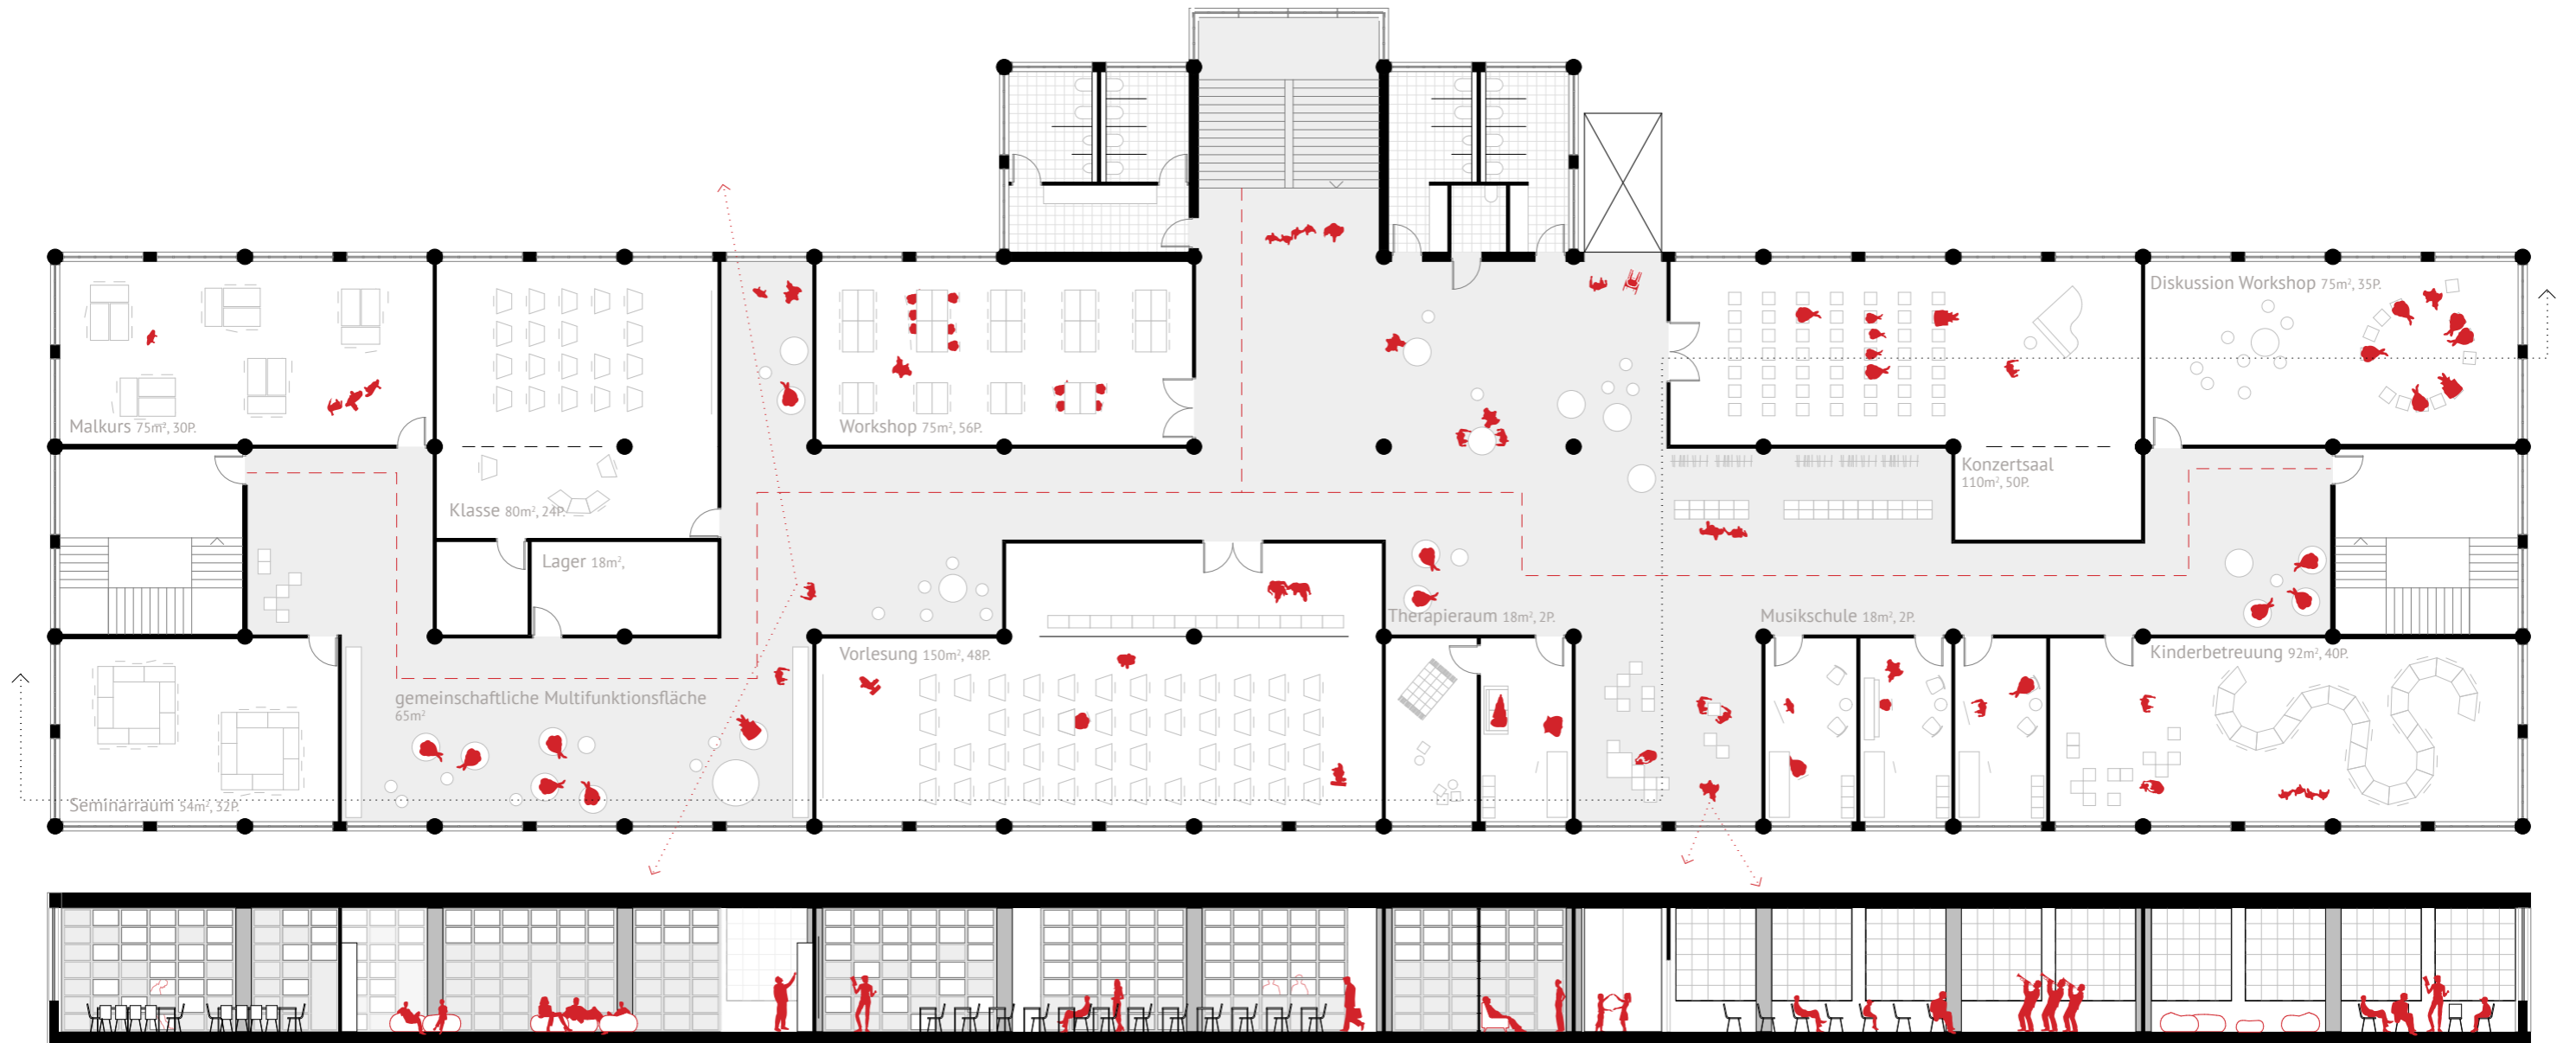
Grundrissvariante mit Räumlichkeiten 10 bis 100 m²
